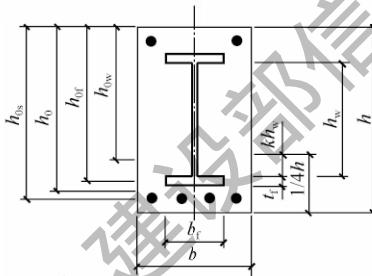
型钢混凝土梁最大裂缝宽度计算参数示意
